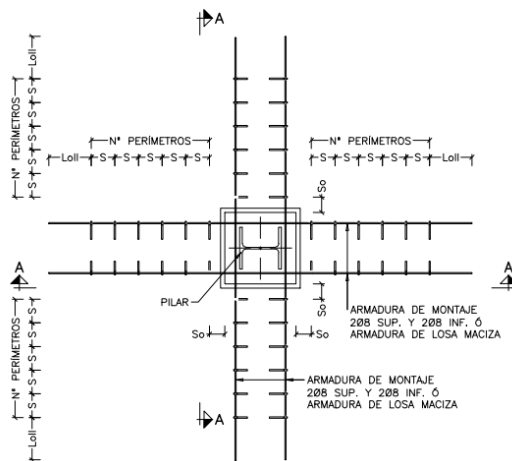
Detalle general armadura de punzonamiento con horquilla (izq.)
